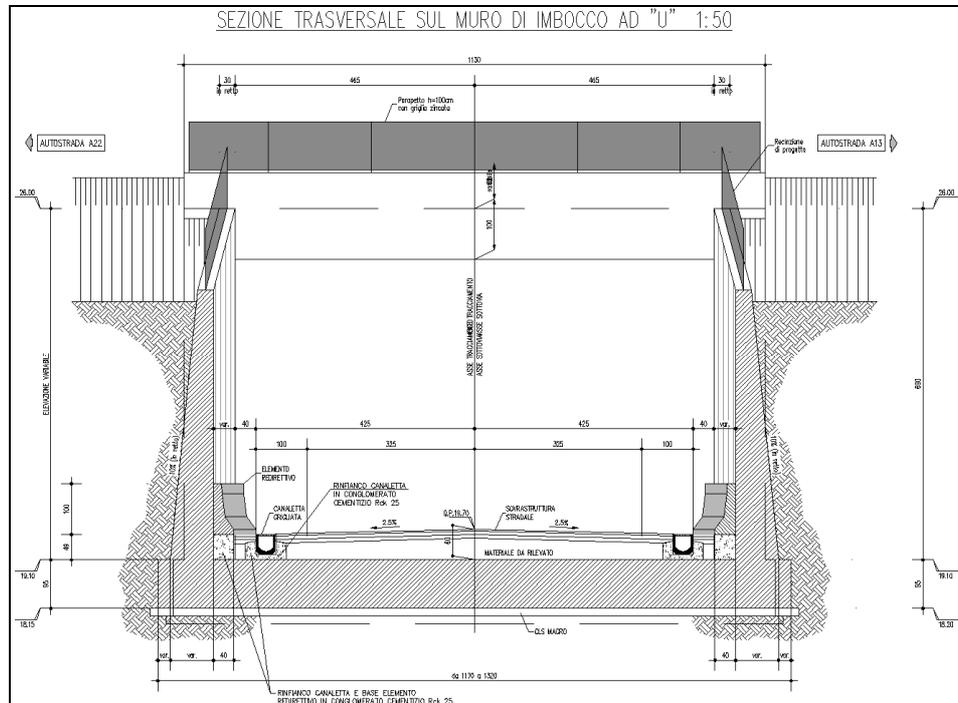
SEZIONE TRASVERSALE SUL MURO DI IMBOCCO AD “U”
